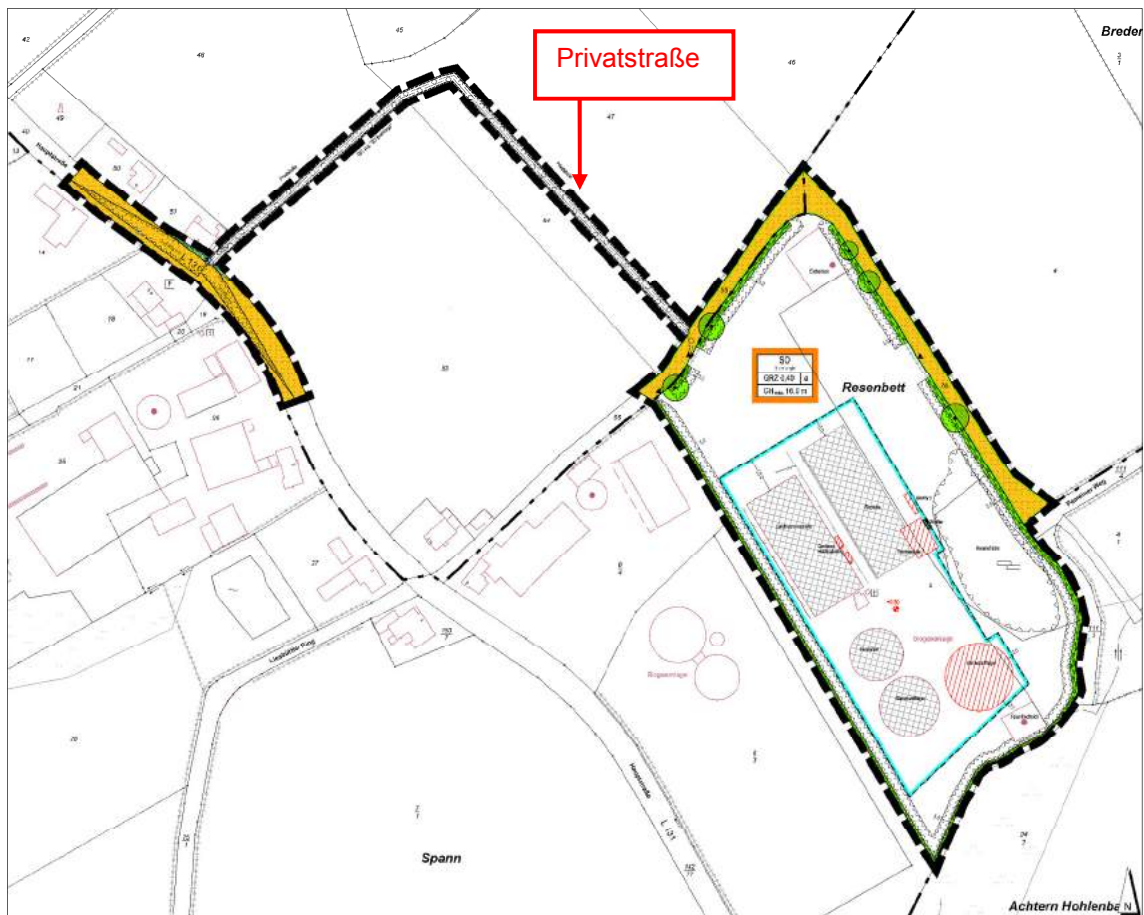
Auszug aus dem B-Plan mit Anlagengelände der Biogasanlage (orange) und Privatstraße (gelb)
